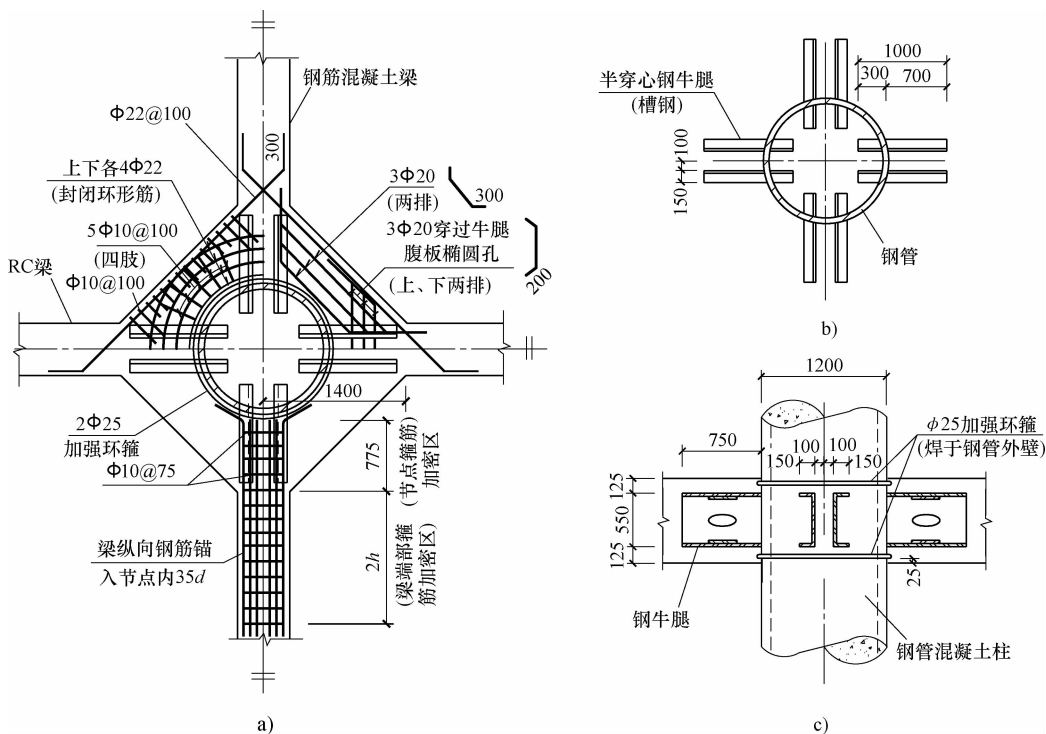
钢管混凝土柱与钢筋混凝土梁的连接
